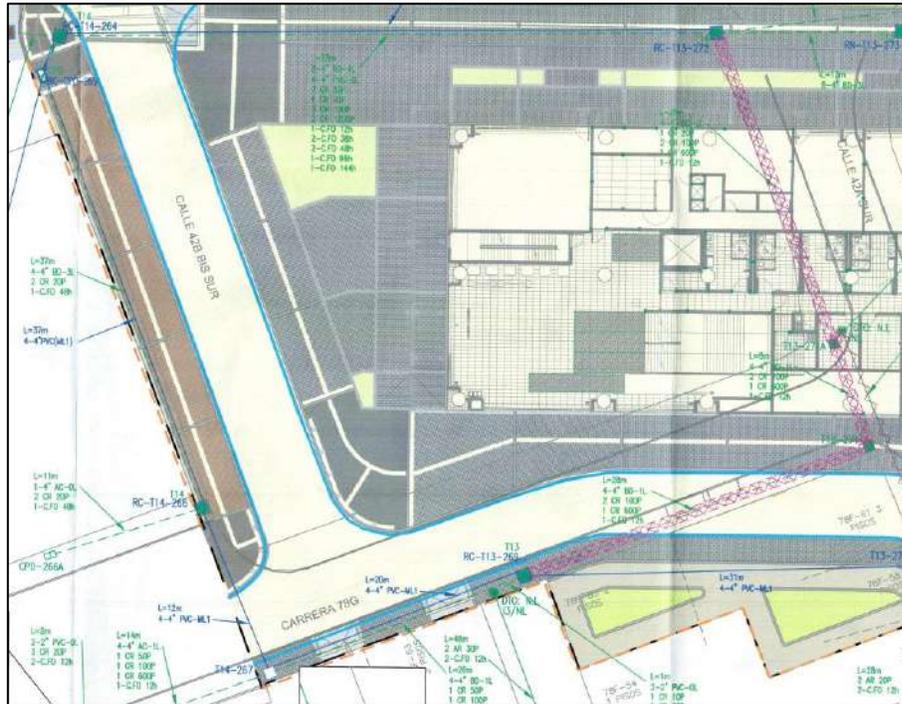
Plano de localización general de la red ETB2-07 entre E4-1 a E4-7
